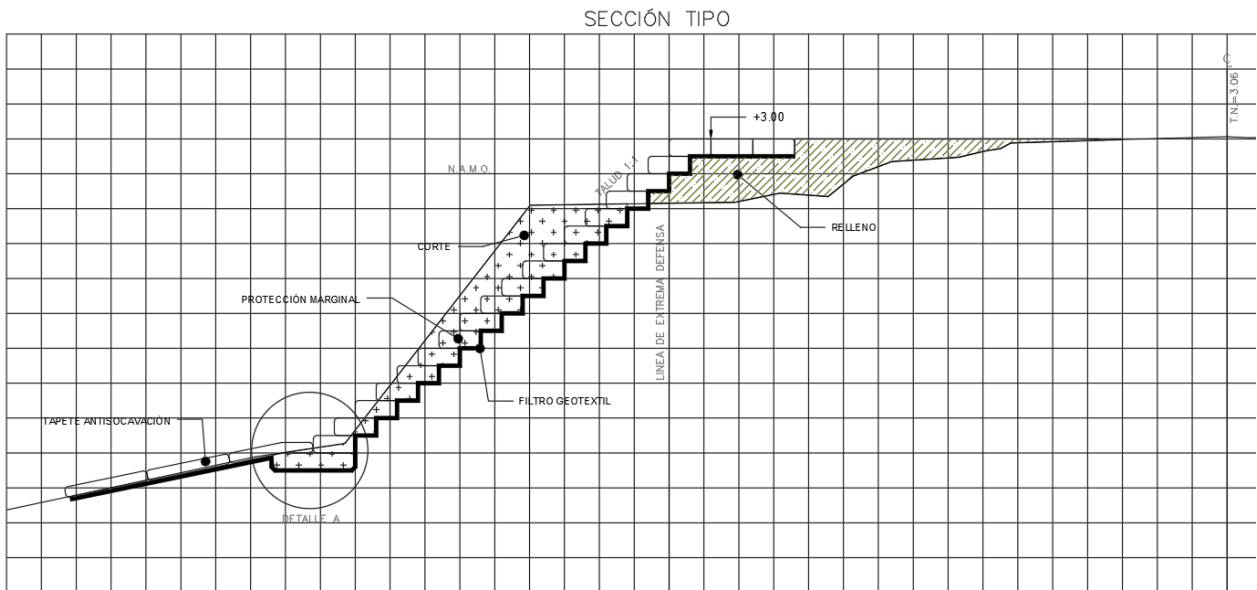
Vista de la sección tipo de la protección marginal donde se aprecian detalles de esta.
